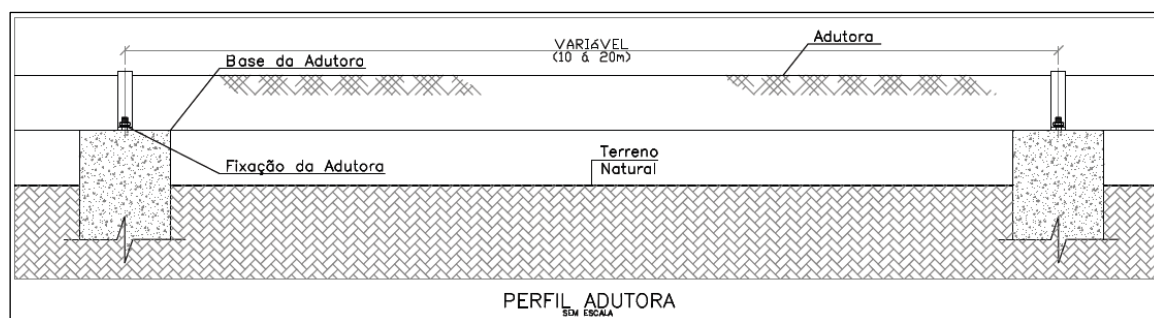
Perfil tipo da adutora.
